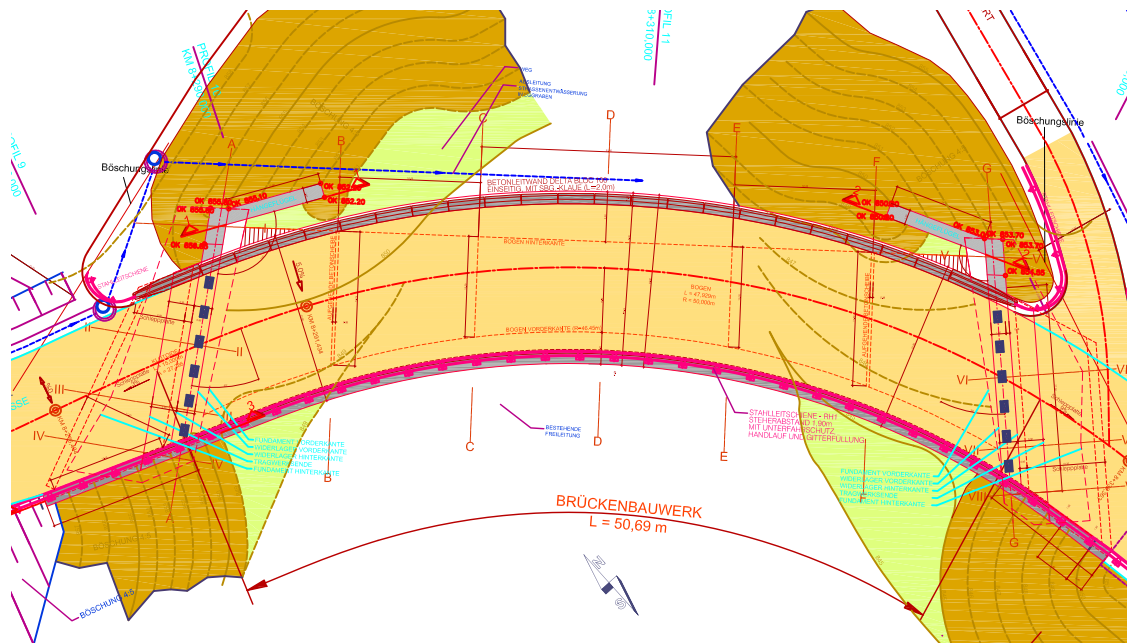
Grundriss der Egg-Grabenbrücke
